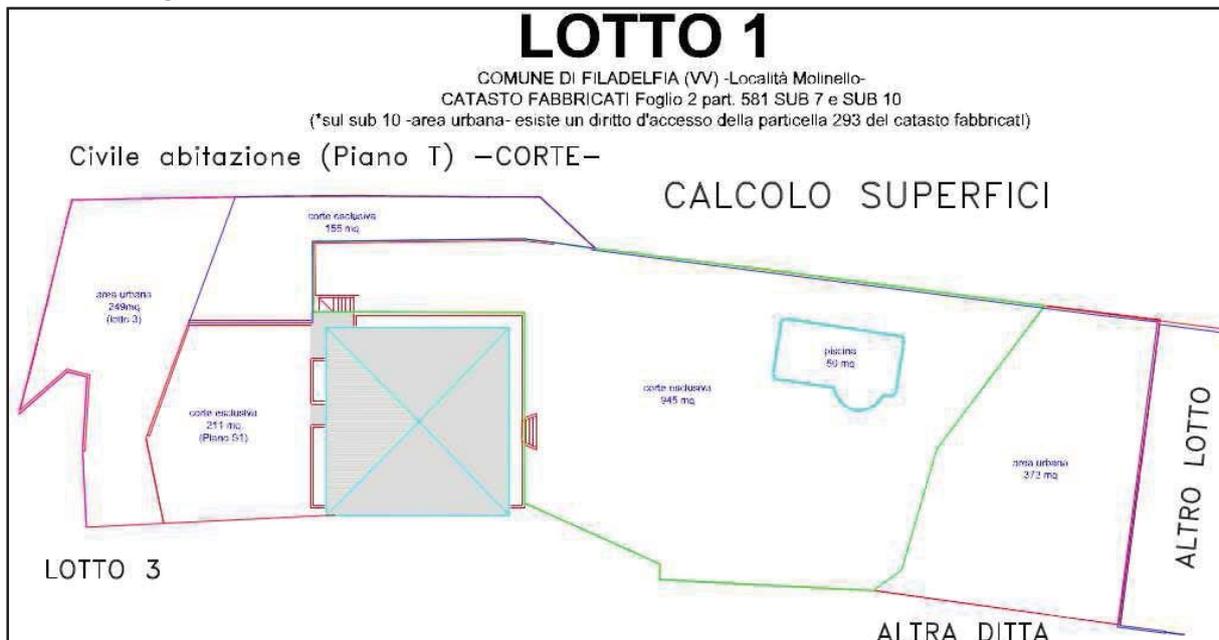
planimetria lotto 1 piano terra calcolo superfici
